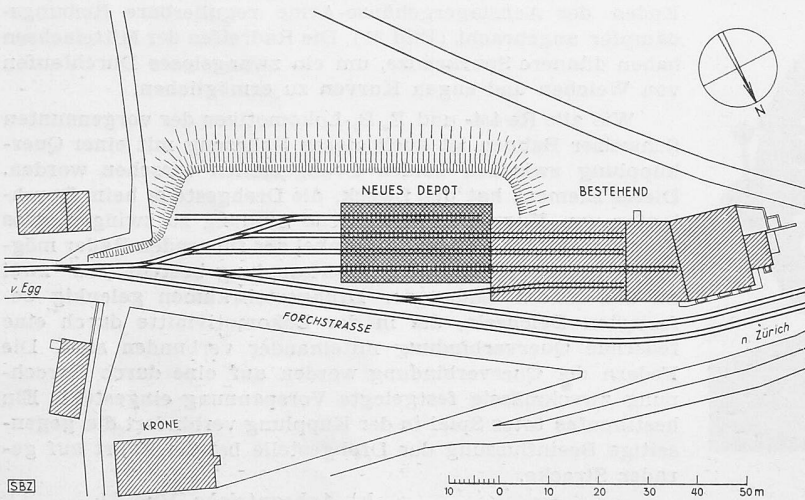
Die Bahnanlagen auf der Forch, Lageplan 1 : 1500
